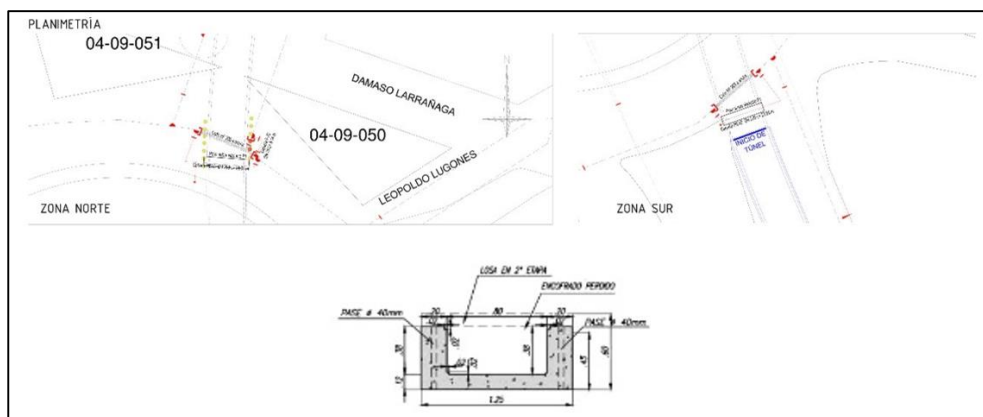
Ubicación de la viga cajón en zona sur y zona norte para la protección del caño DN 200. Detalle de la misma. (PLANO N° 17)
